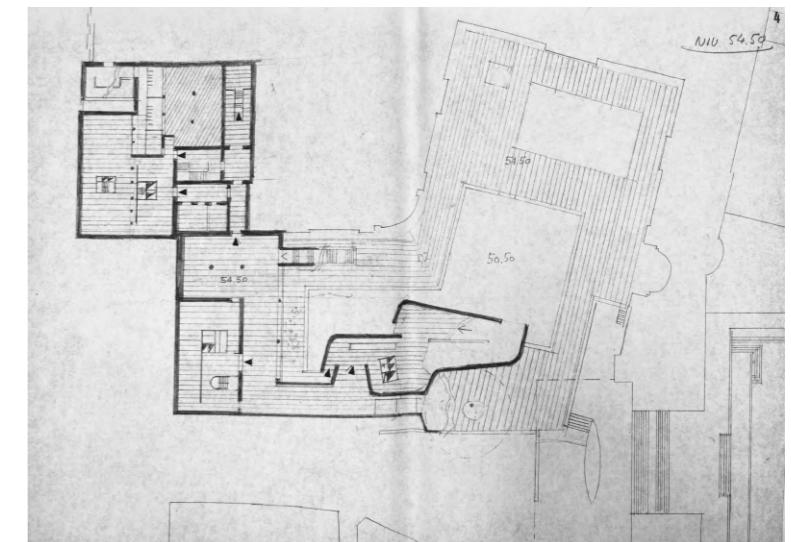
Plan R-1, 7^{ème} esquisse.
